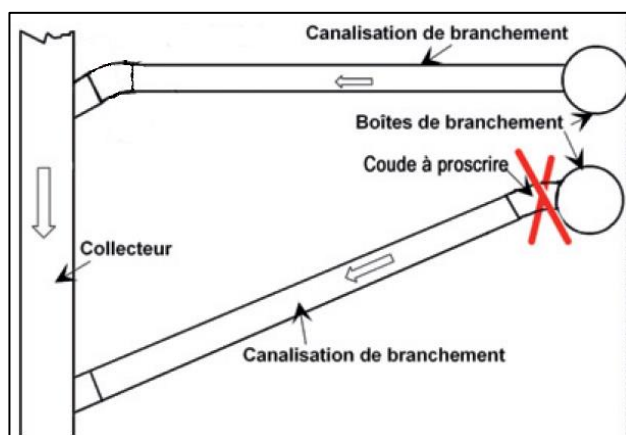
Tracés en plan de configurations acceptée et prohibée sur culotte en Y
